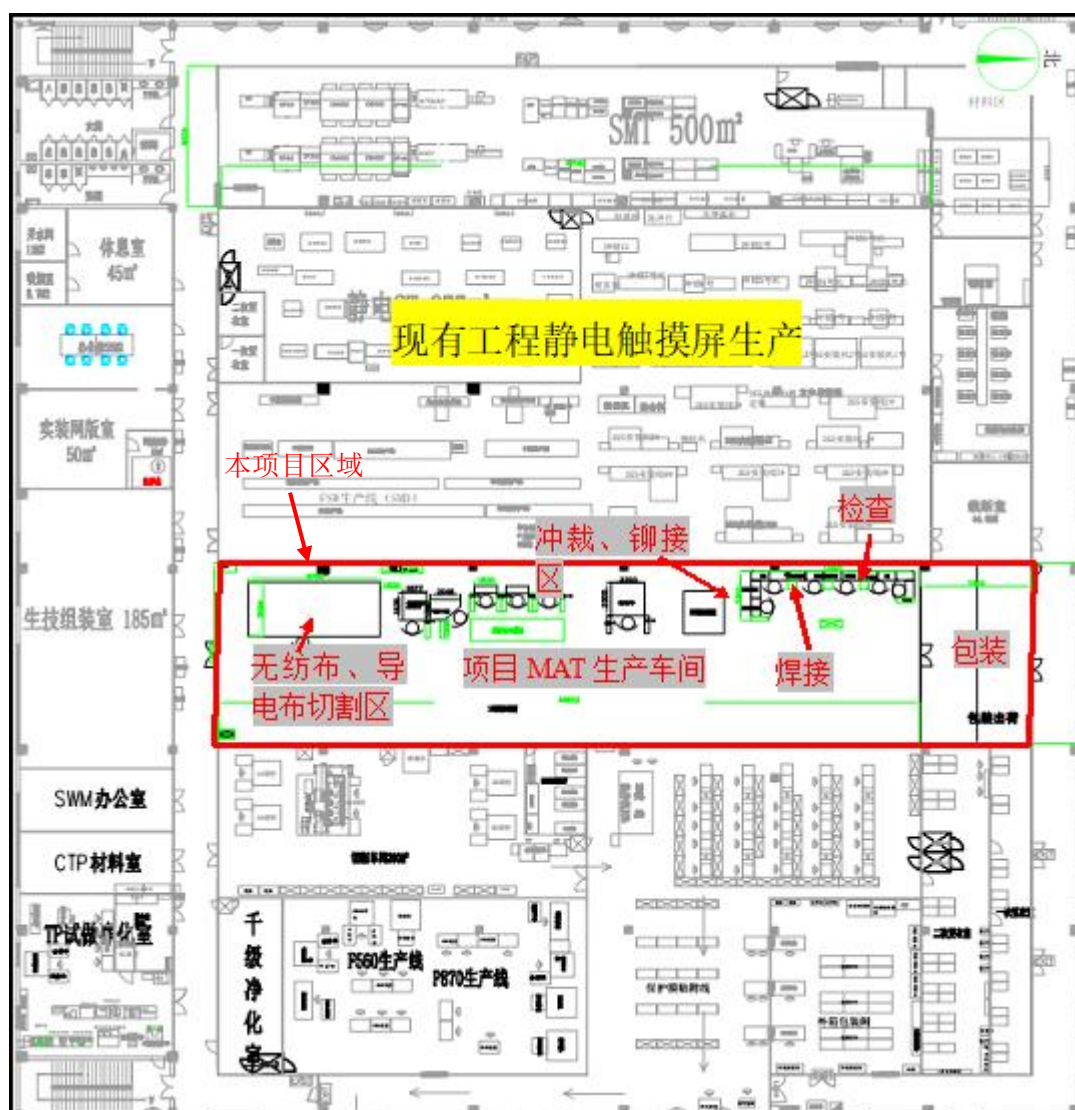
项目所在 C 栋车间第三层平面布置图
